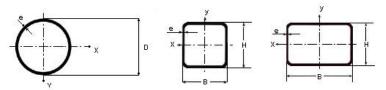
Tipos de tubos estructurales. Fuente: http://constructalia.
